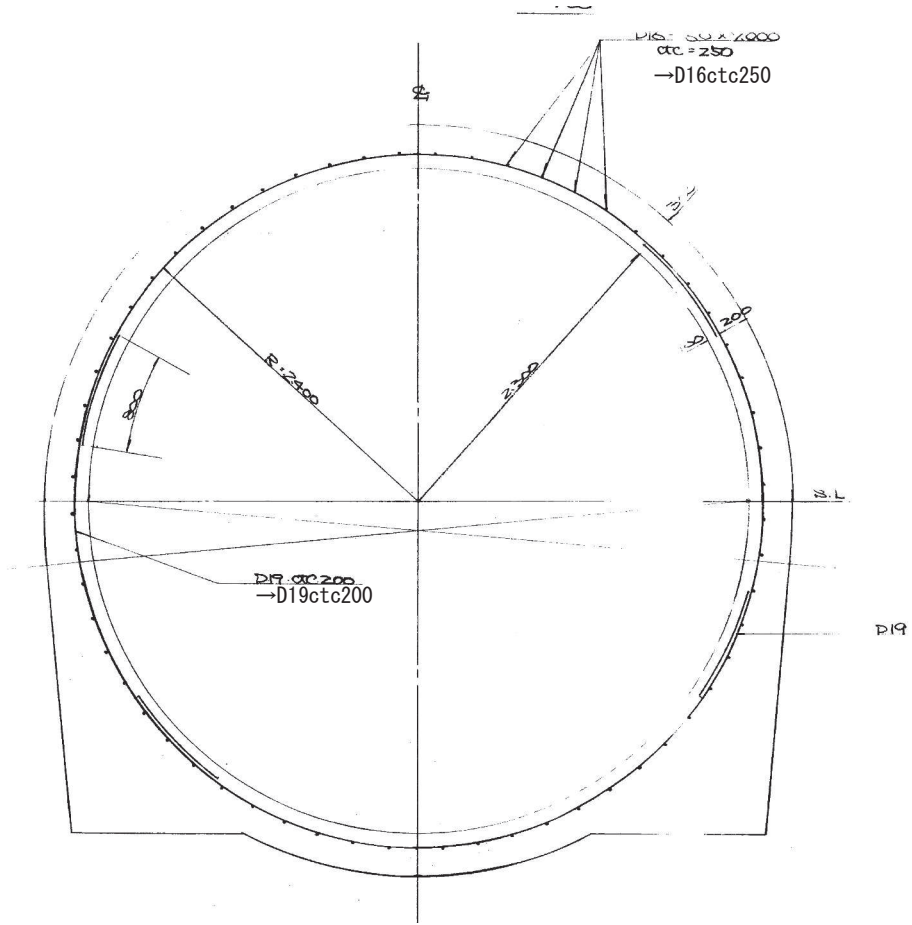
(3) 取放水路流路縮小工（第 1 号機放水路）の構造概要図
